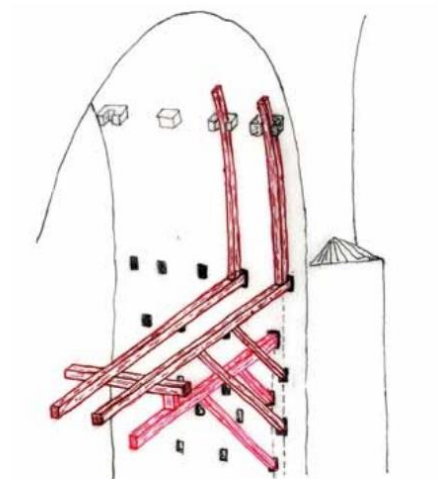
Apoyo de la cimbra y andamios. Fuente: Puentes arcos (I). Historia de los puentes arco. Revista de Obras Públicas.
